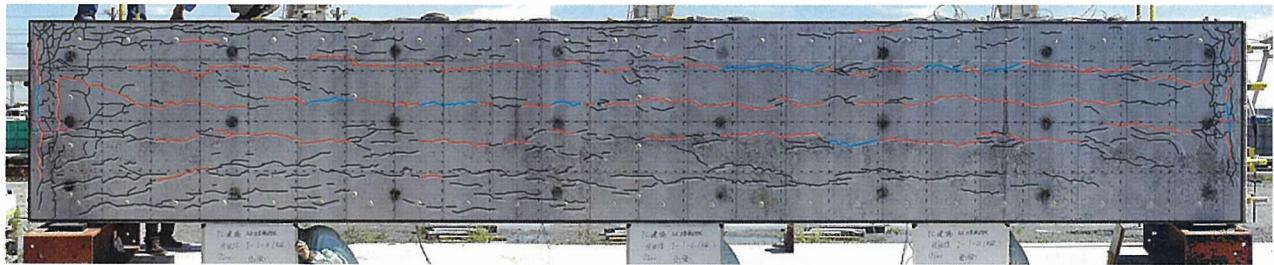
アルカリシリカ反応性骨材を用いた試験体のひび割れ状況（材齢 240 日）
